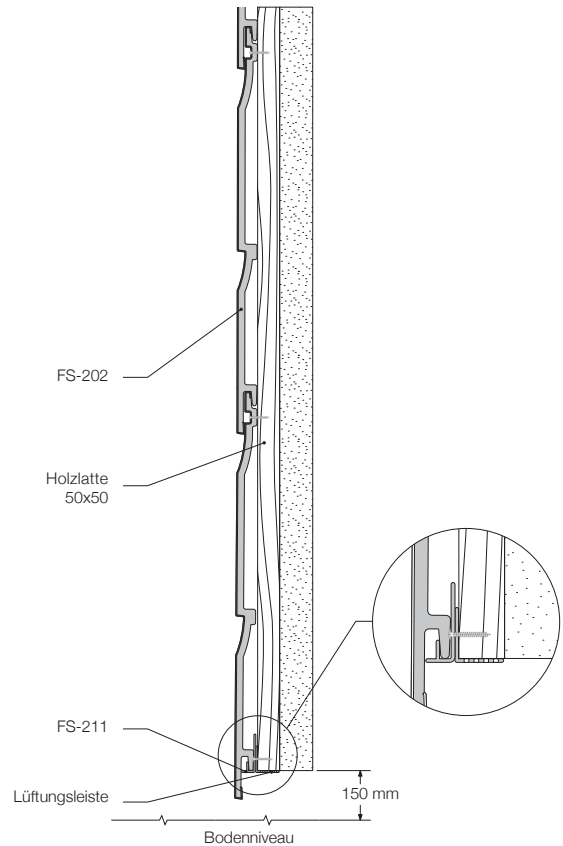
Lüftungsschlitz bei Paneelen mit dunklen Farben erforderlich, Montage an der Mauer – horizontaler Schnitt
